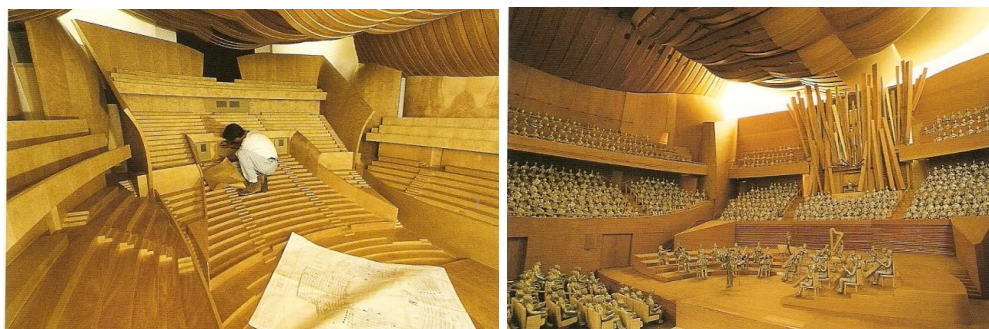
Maquetas gigantes, para definir mejor los detalles constructivos.<sup>56</sup>
